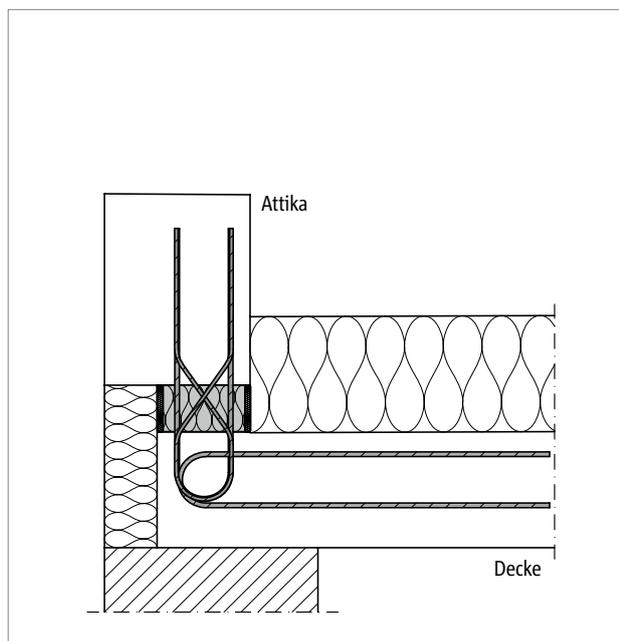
Schöck Isokorb® T Typ A: Anschluss einer Attika (T Typ A-MM1)
